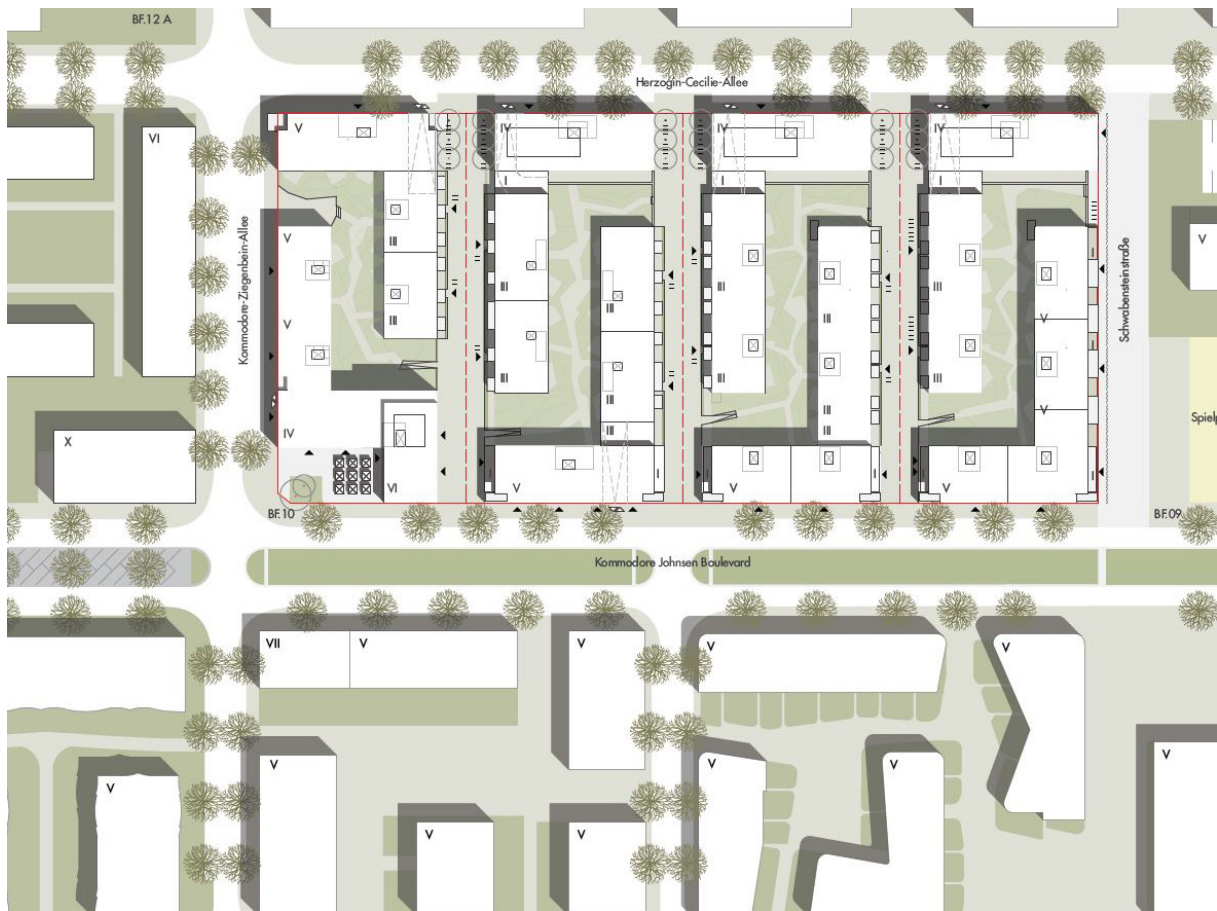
Ausschnitt Lageplan Winking-Froh Architekten GmbH vom April 2017
